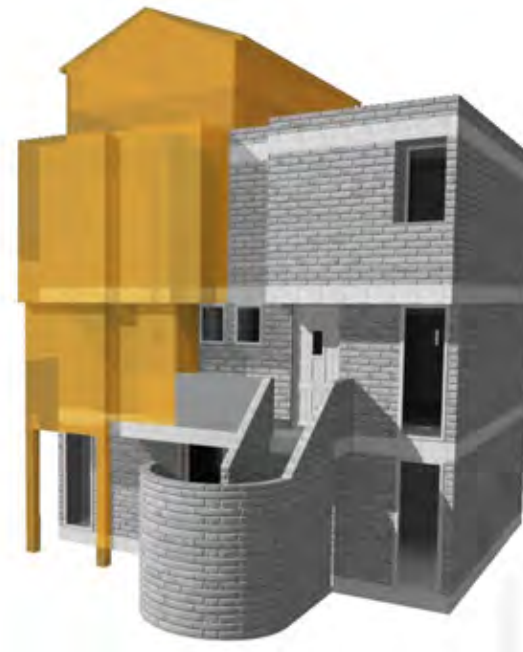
Modelo en 3D del Edificio D indicando con color la modificación por construcción que presenta la vivienda. Fuente: propia 2018
